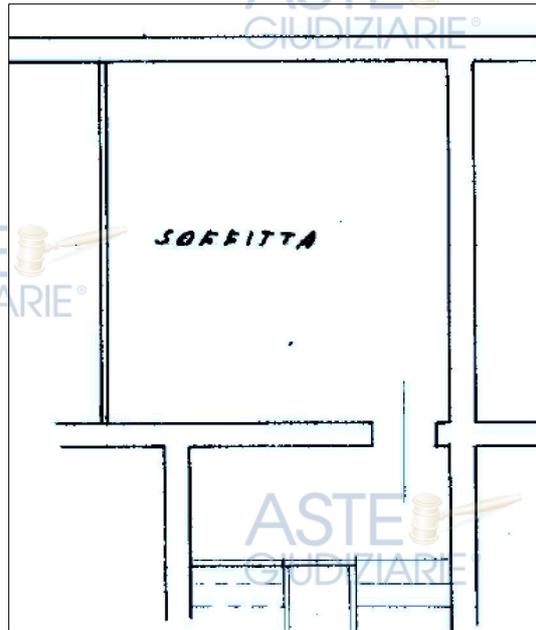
Estratto della planimetria catastale, foglio 6 particella 225 sub 2. Soffitta.
